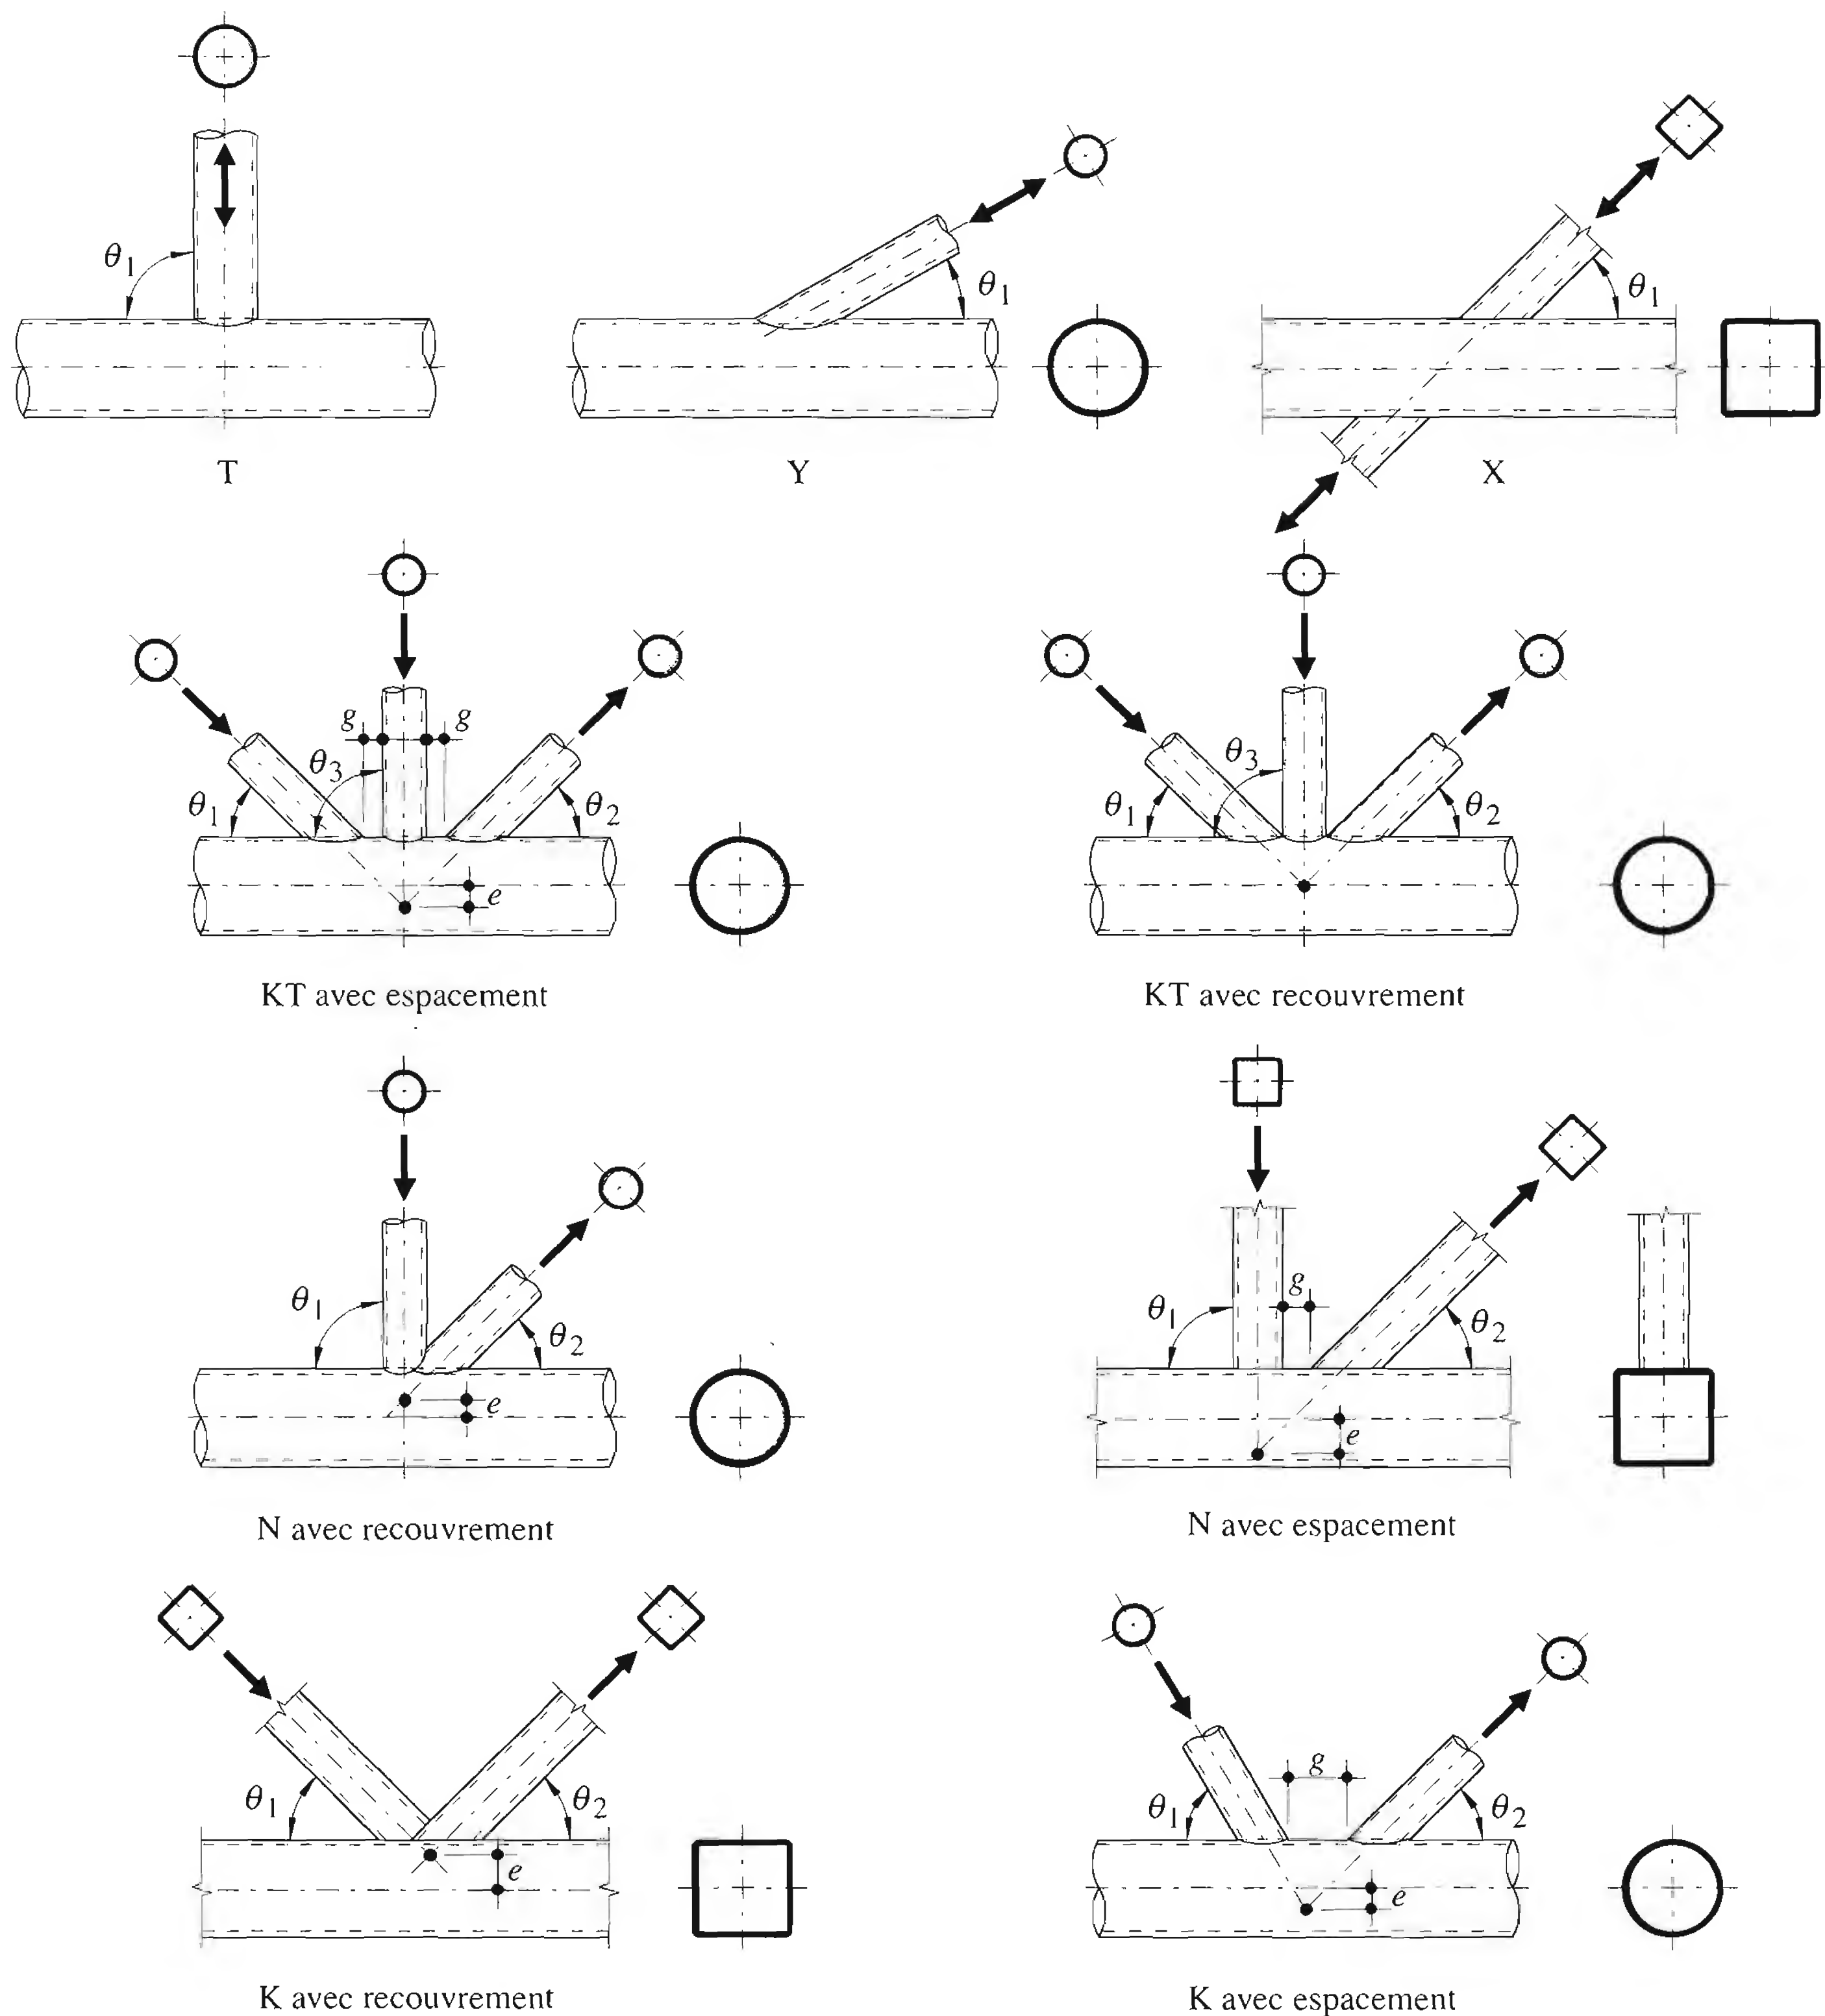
Types d'assemblage de profils creux circulaires et rectangulaires.
